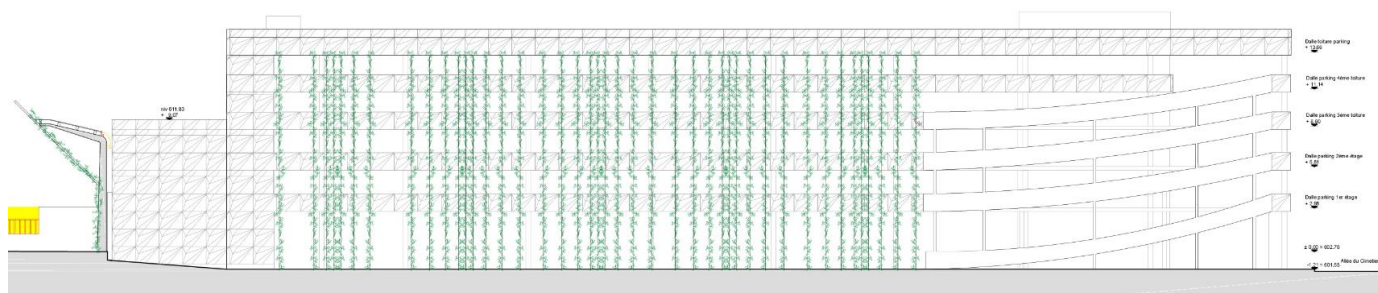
Élévation du parking sur le chemin Saint-Léonard
